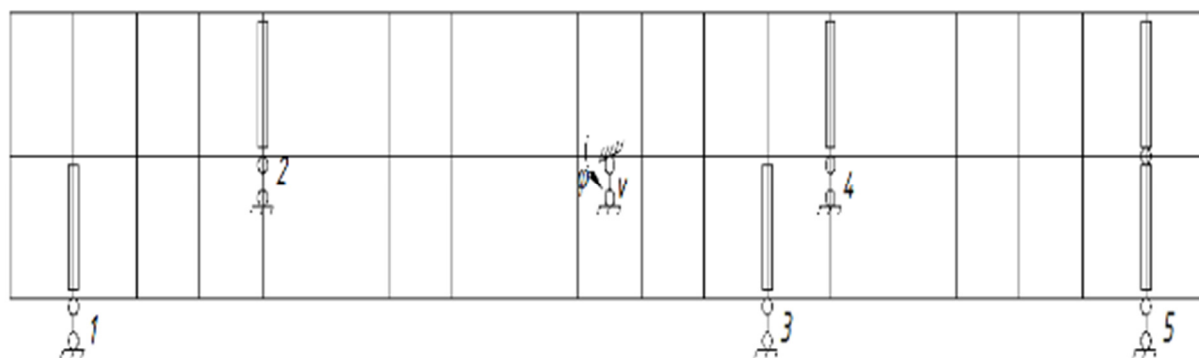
Схема расположения расчетных точек и мостовых кранов на плане здания
